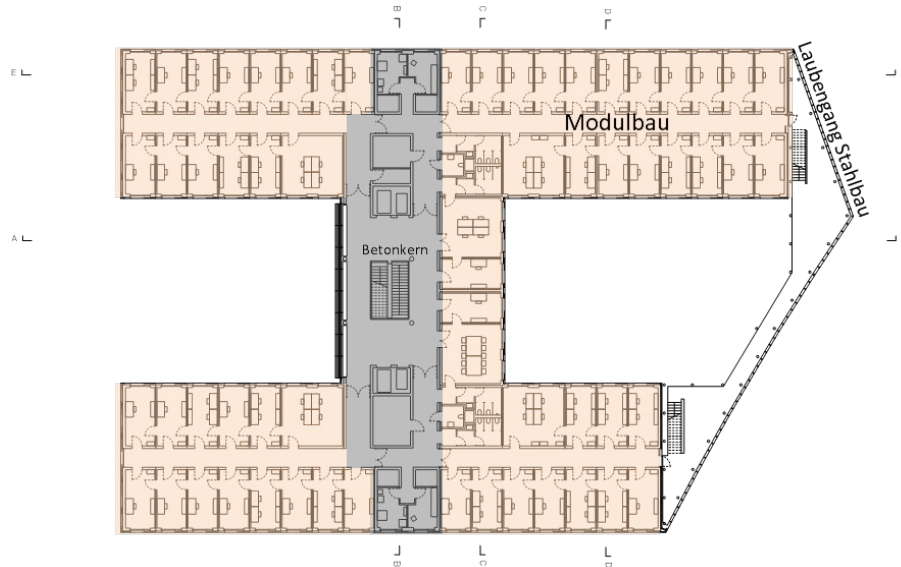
Grundriss Luisenblock West © Kaufmann Bausysteme GmbH
